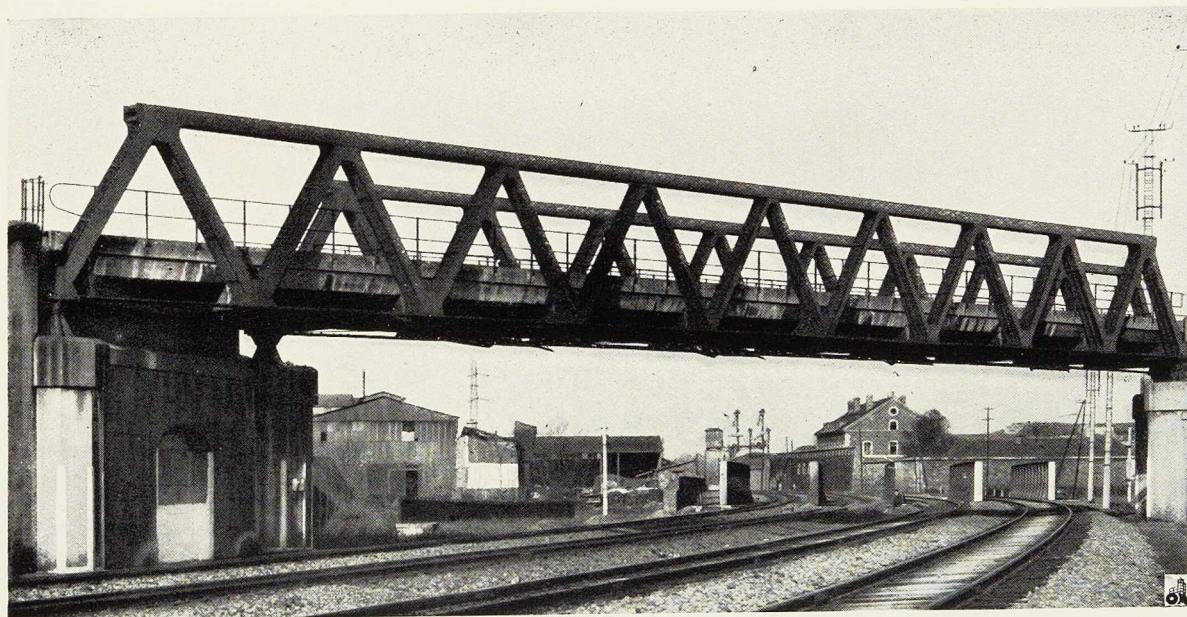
Pont des Joncherolles réalisé en acier à haute résistance assemblé par soudure.
